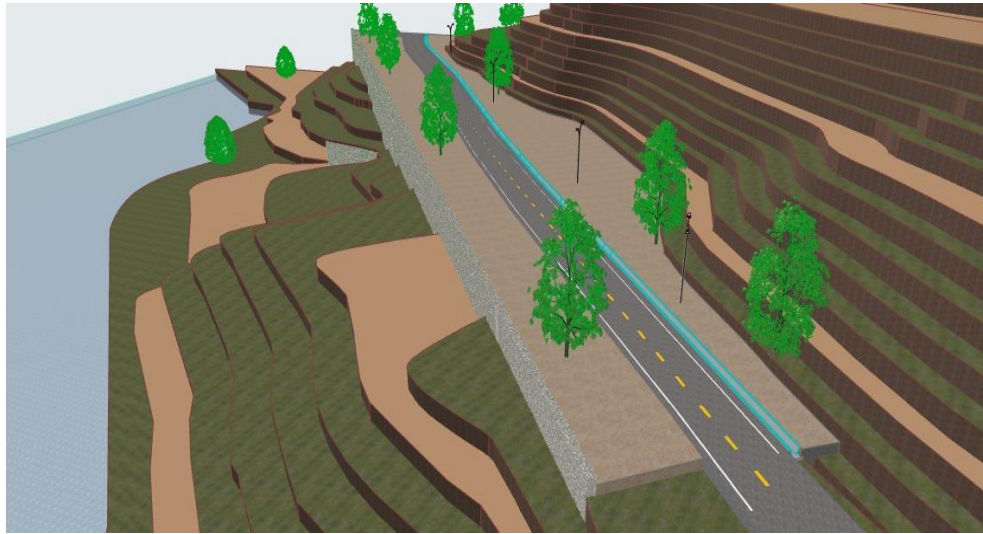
Modelado Bim del muro de gaviones con vista posterior
